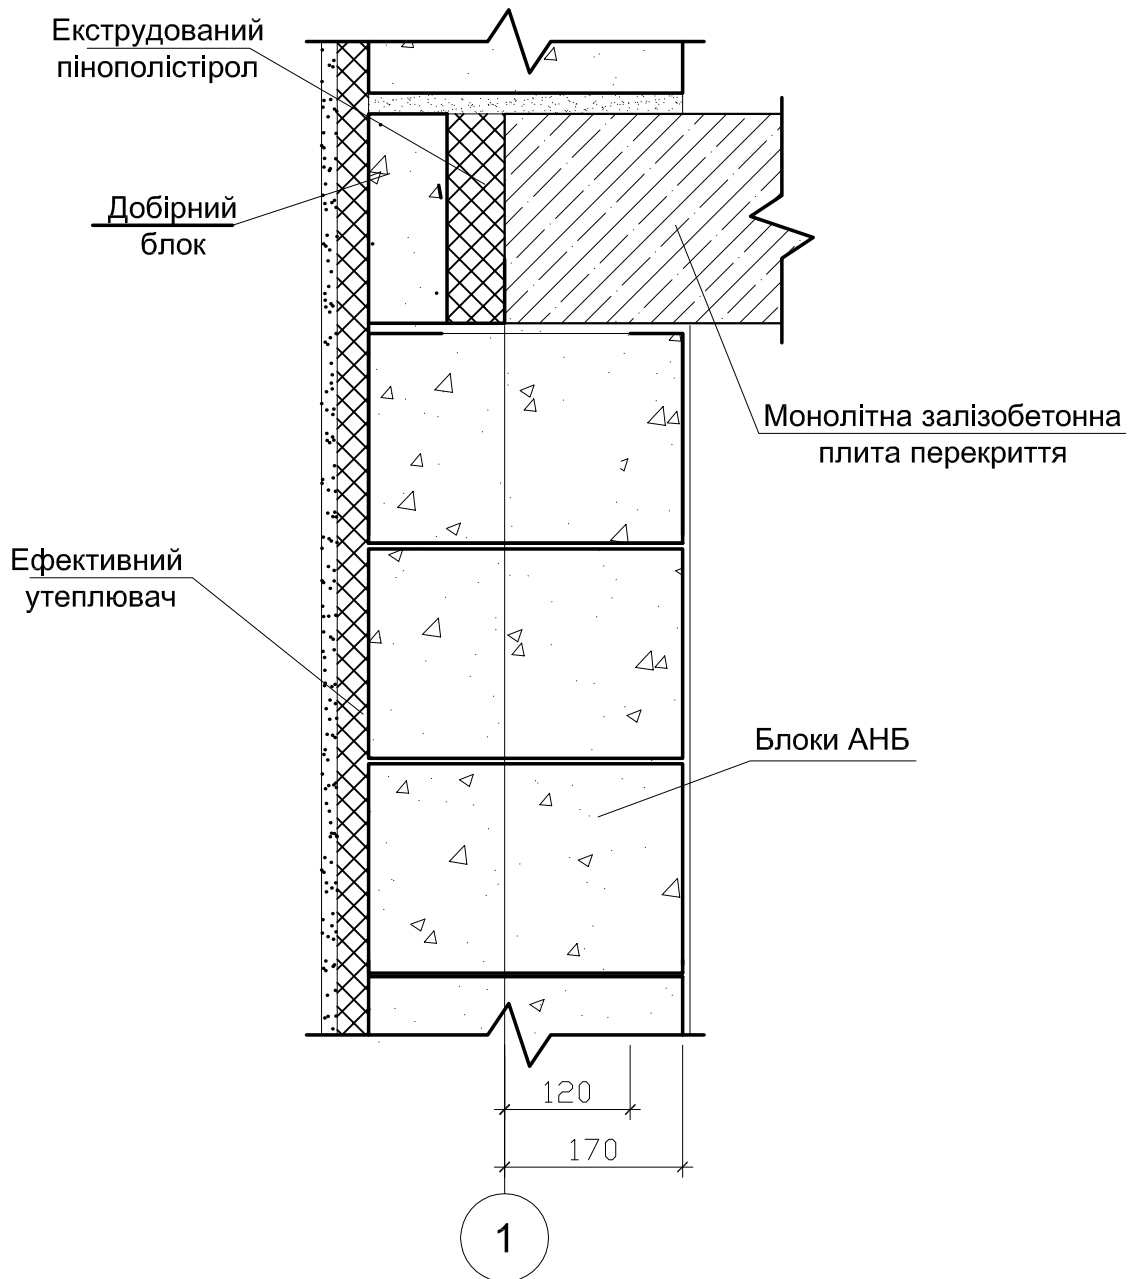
Спирання монолітного залізобетонного перекриття на зовнішню стіну з АНБ
